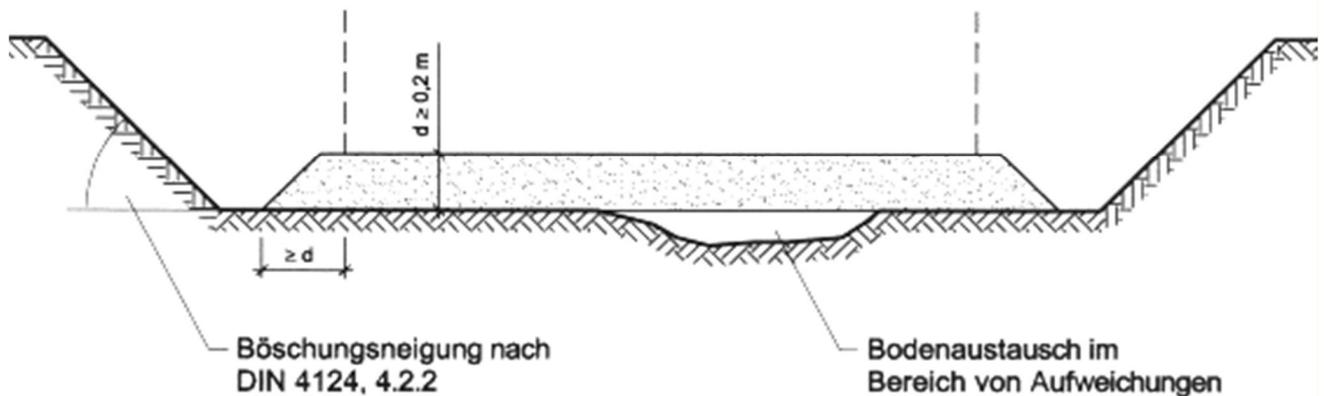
schematischer Aufbau der Planumsschutzschicht
